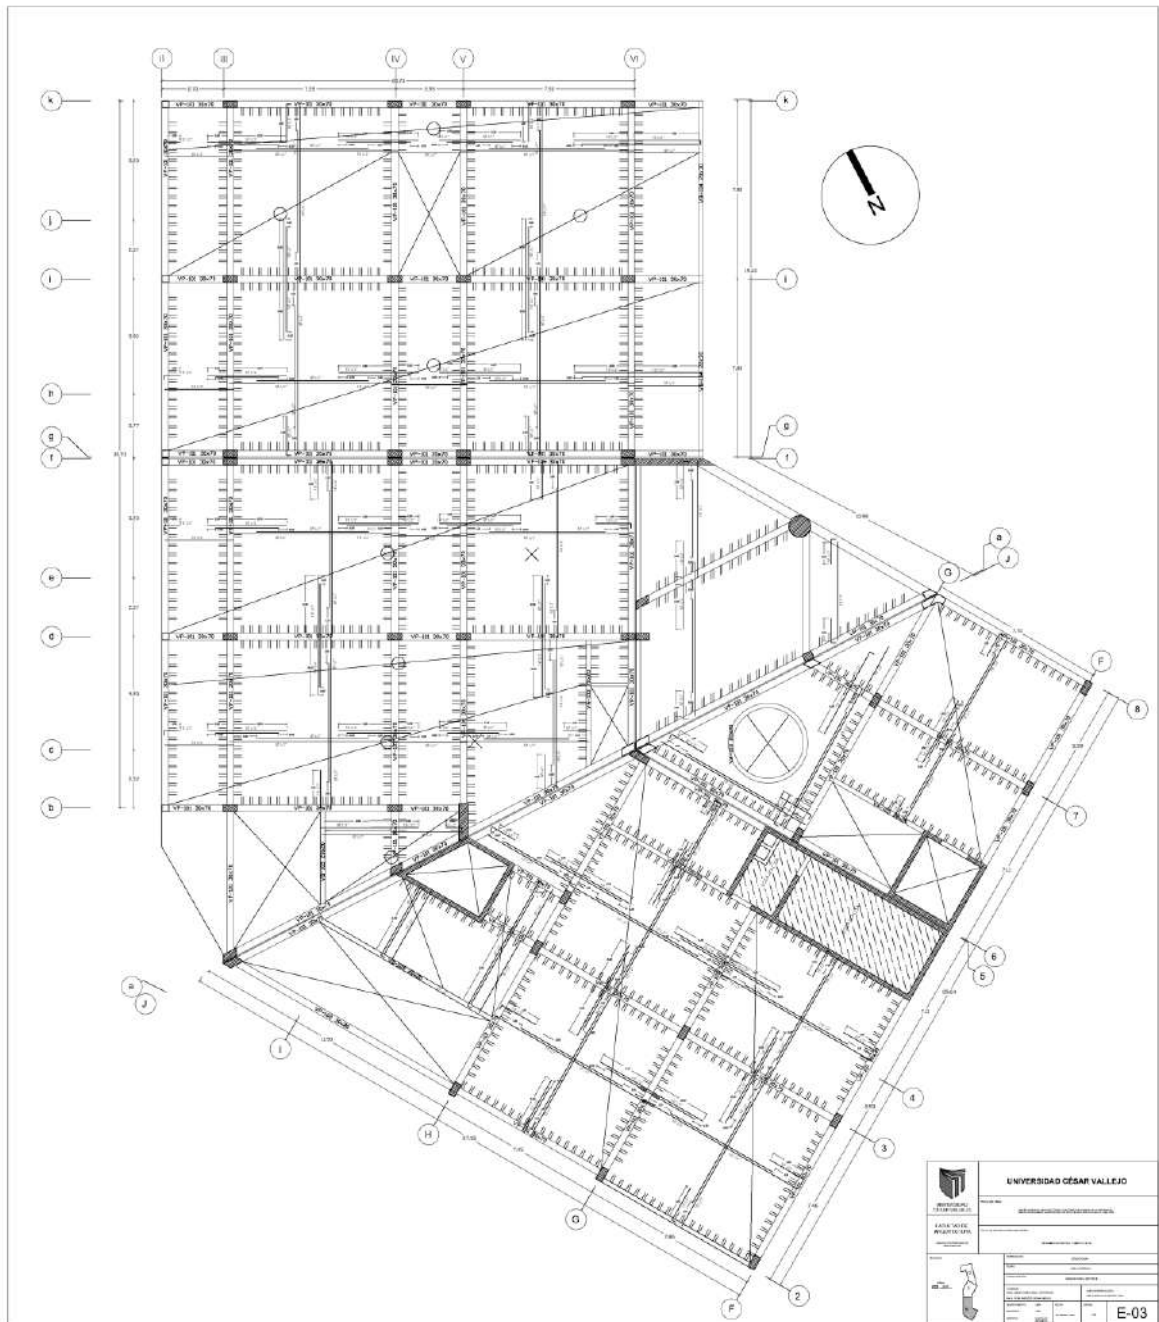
Aligerado - Segundo piso sector B - ESTRUCTURAS
